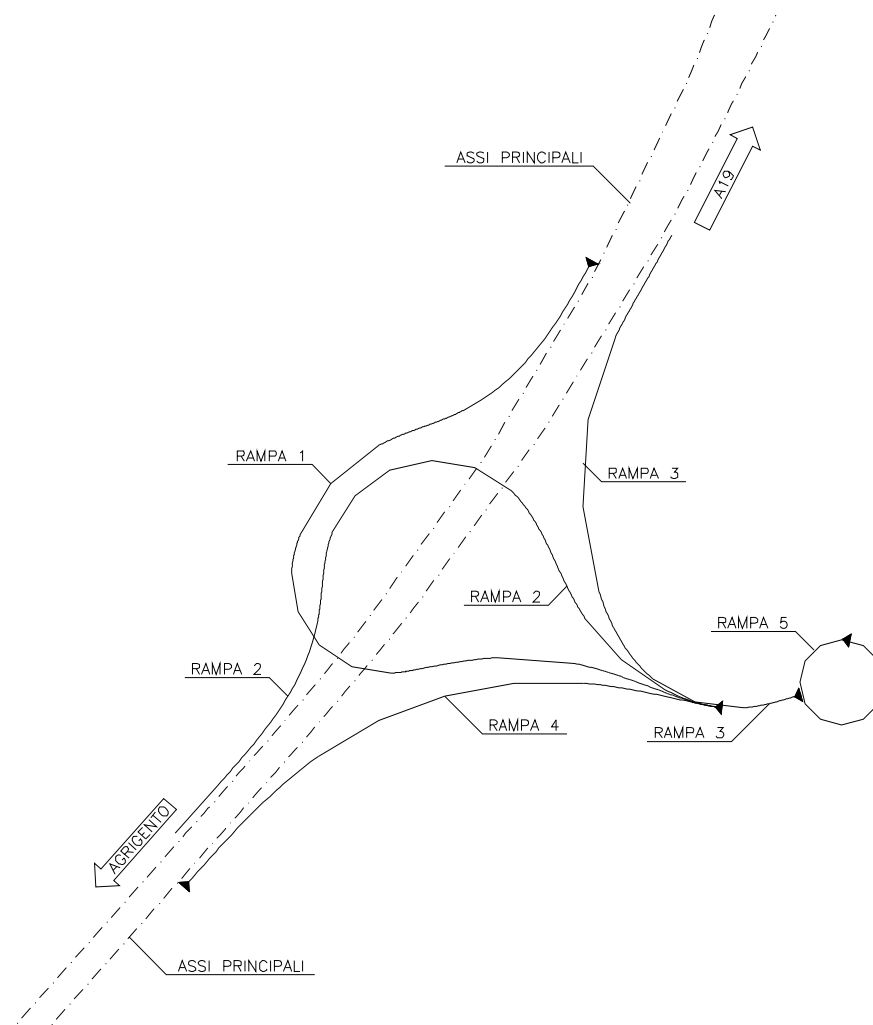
Svincolo Caltanissetta sud- Planimetria schematica
